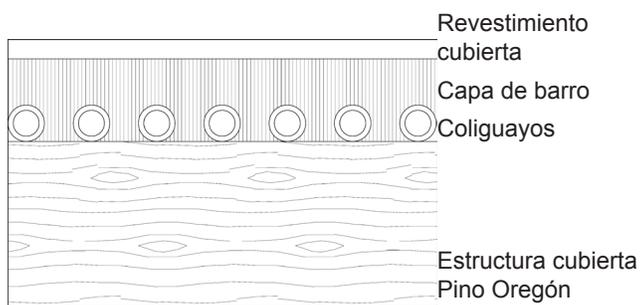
Esquema aislamiento cubierta edificio ex Congreso Nacional. Elaboración propia
